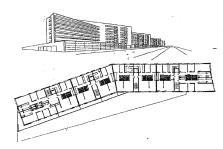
Ejemplo de zócalo. Viviendas en Avenida Icaria, Barcelona, Joan Pascual. Fuente: Manzanas, bloques y casas. Autor: Pérez Igualada, Javier. 2003, p. 216.
